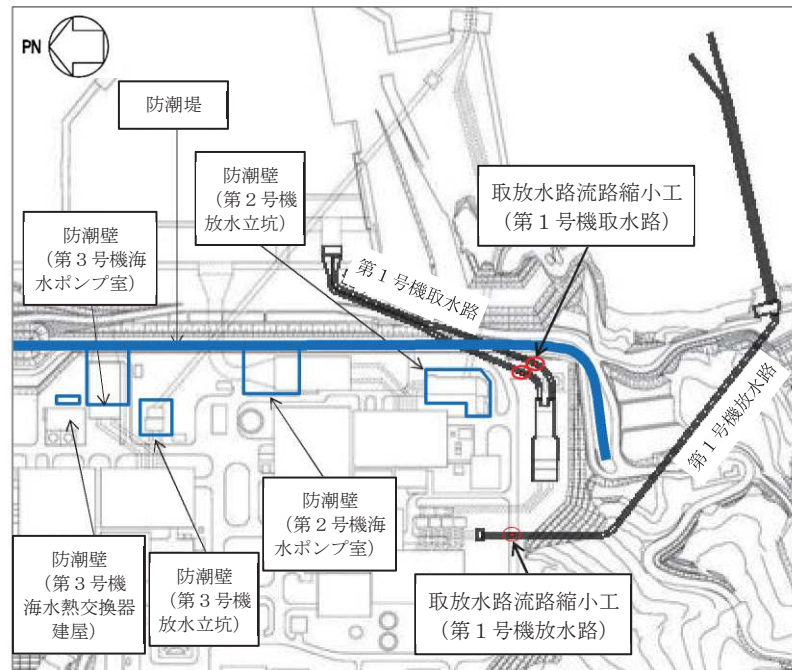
取放水路流路縮小工（第1号機放水路）の位置図（全体平面図）
